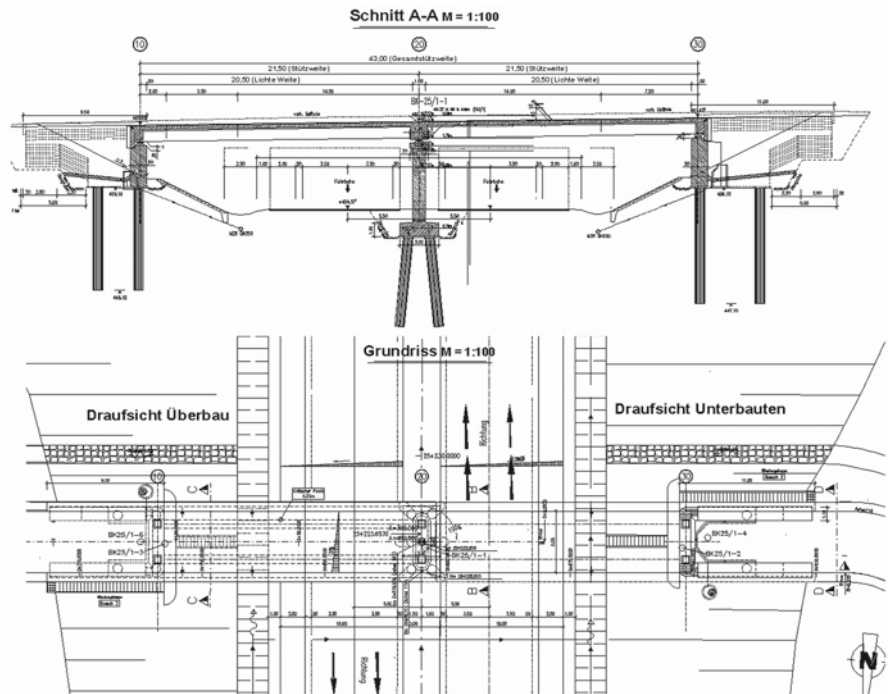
Ansicht, Längsschnitt und Grundriss des Bauwerksentwurfsplans. (Quelle: Autobahndirektion Südbayern)
